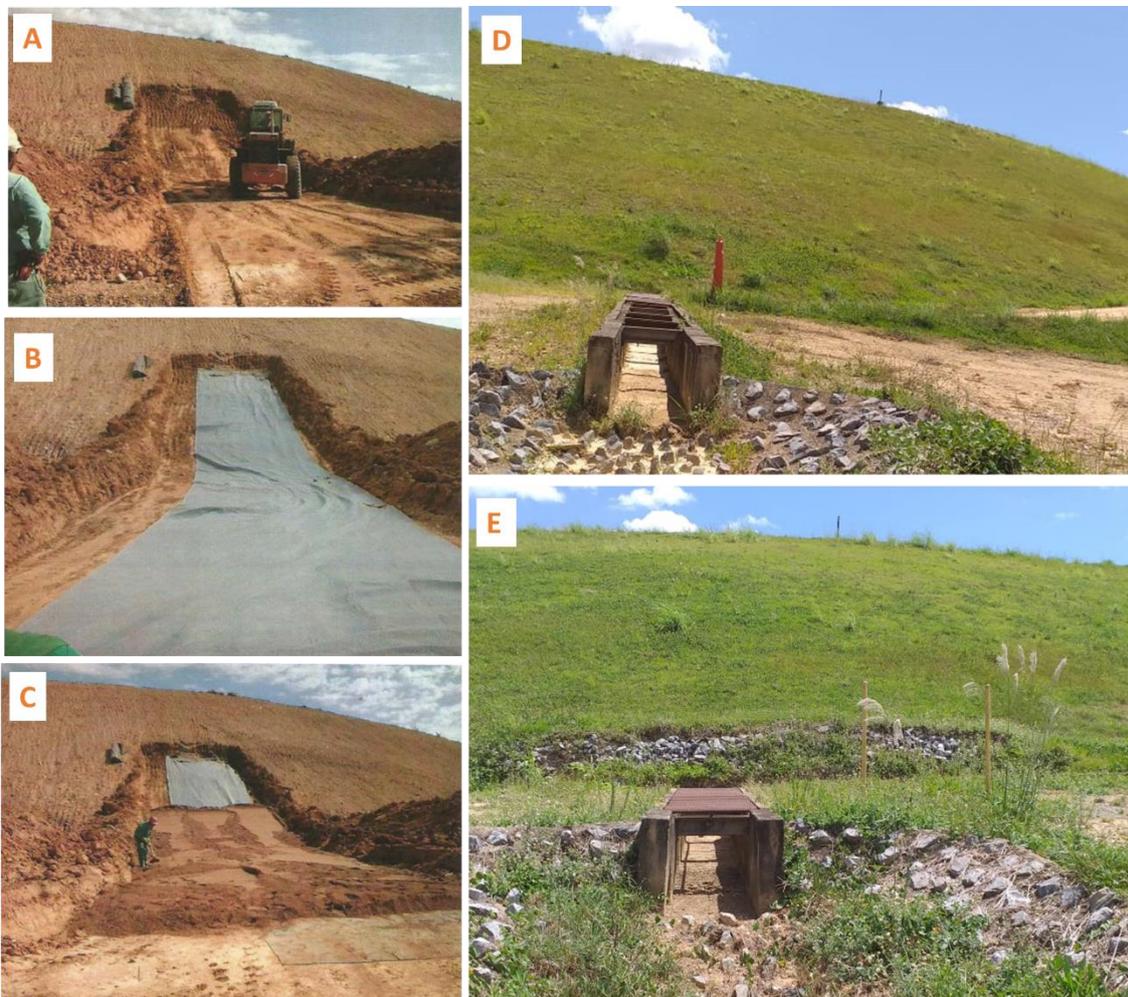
Sistema de drenagem interna: A) Regularização da escavação do dreno. B) Aplicação da manta geotêxtil. C) Lançamento de areia sobre a manta geotêxtil. D) e E) Taludes íntegros, sem sinais de comprometimento da drenagem interna.
